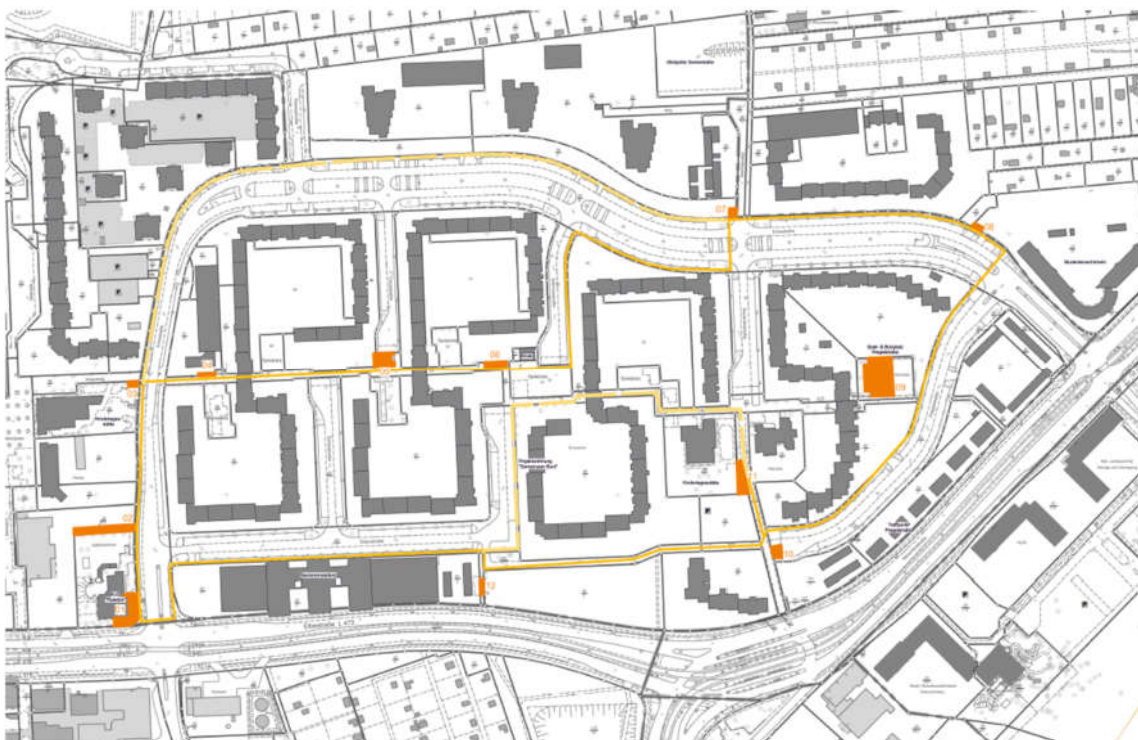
Lebensweg im Emsviertel – Stationen Lebensweg – Lageplan
